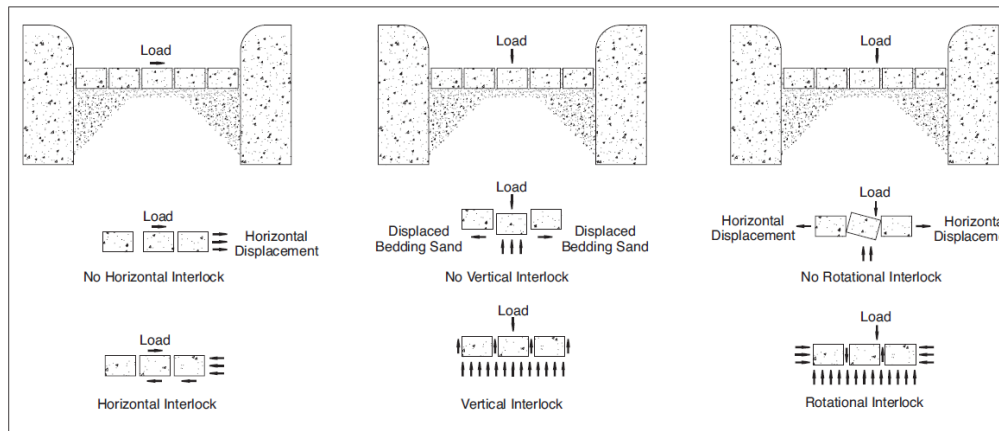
Tipos de trabazón en adoquines, horizontal, vertical y rotacional (Interlocking Concrete Pavement Institute, ICPI)
